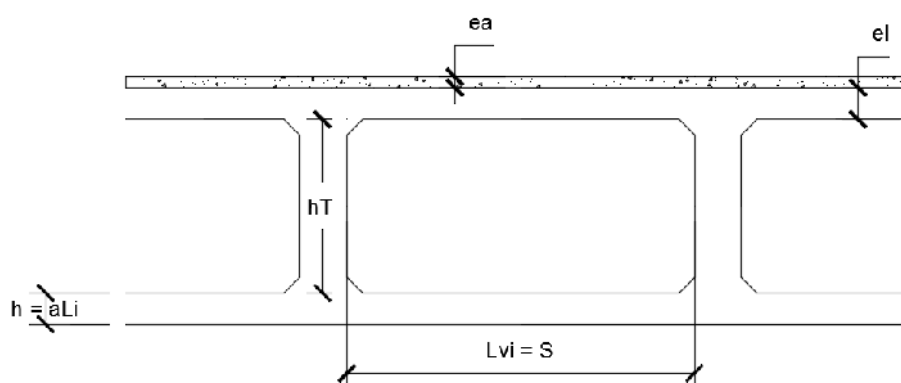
Detalle de longitudes en el tablero utilizadas en los cálculos (Fuente: elaboración propia)
